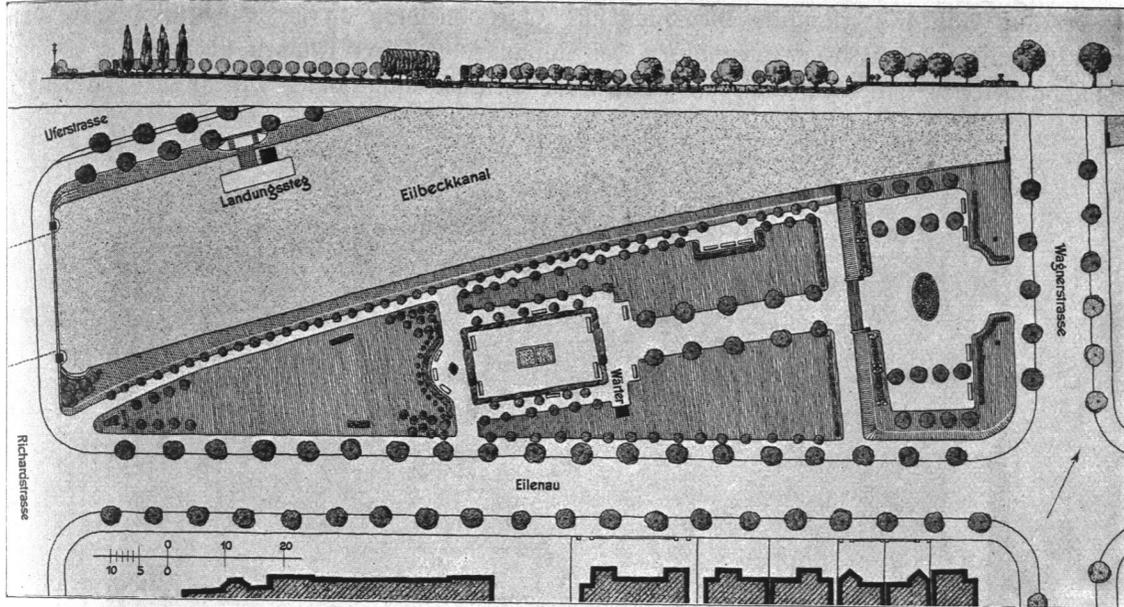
Grünanlage Eilbecktal-Wagnerstraße, Lageplan.
